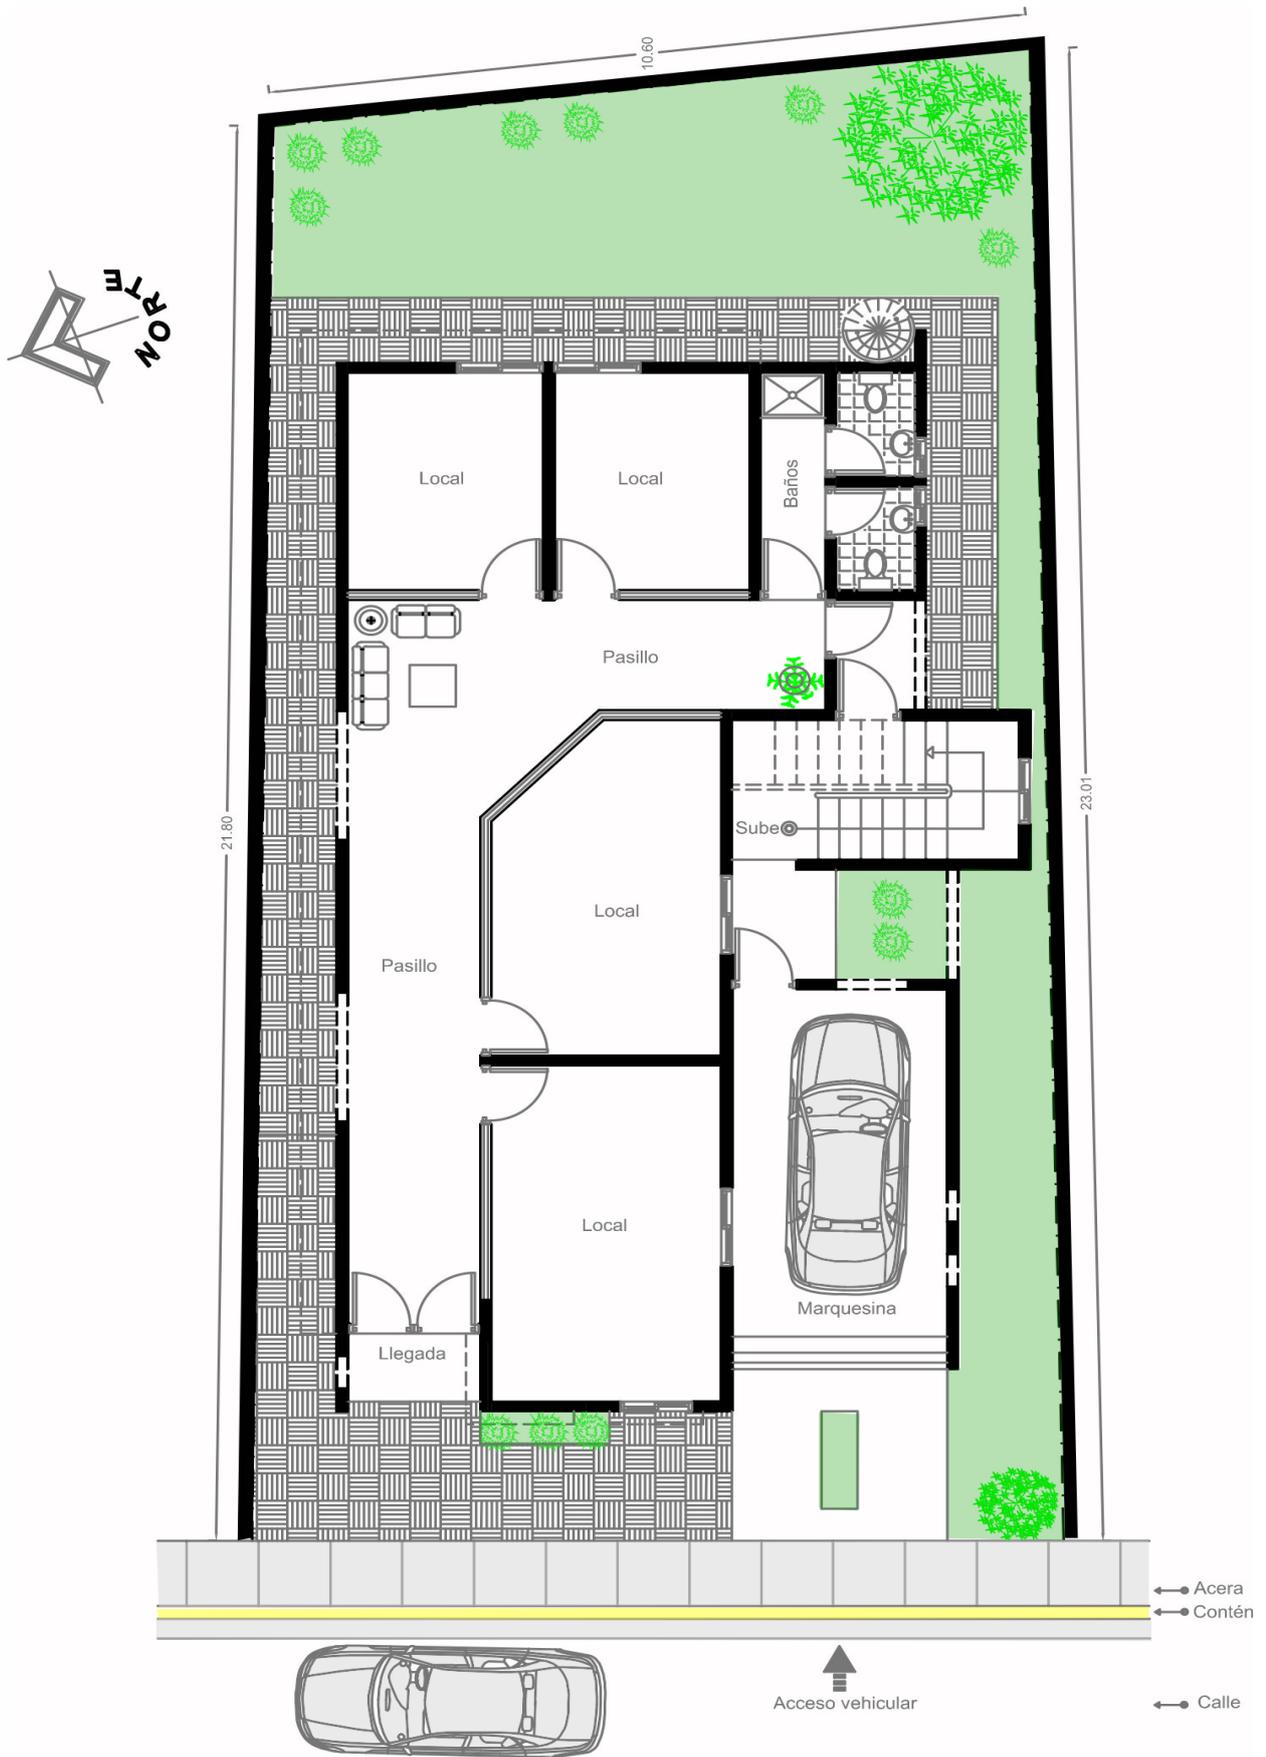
PLANTA ARQ. DE CONJUNTO AMUEBLADA (PLANTA BAJA)
